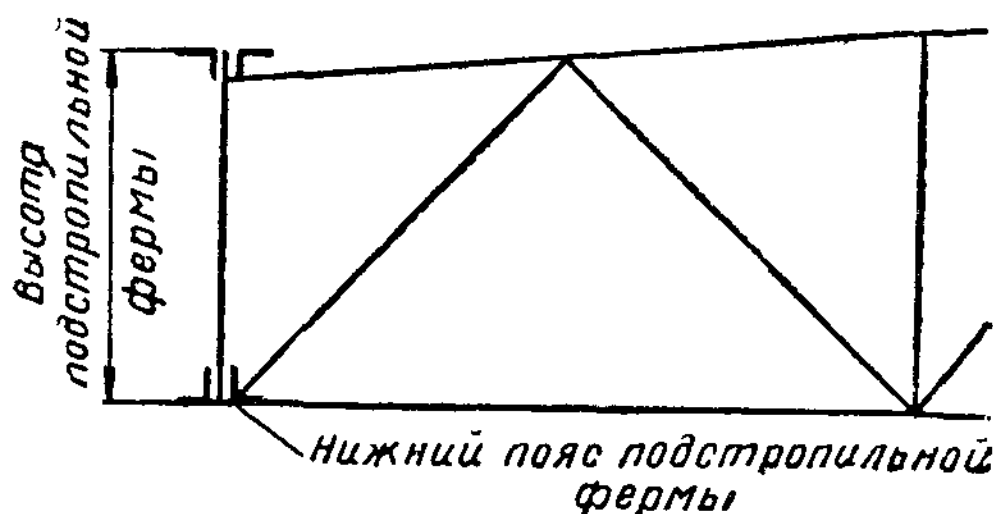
Расположение стропильной и подстропильной ферм в одном уровне
